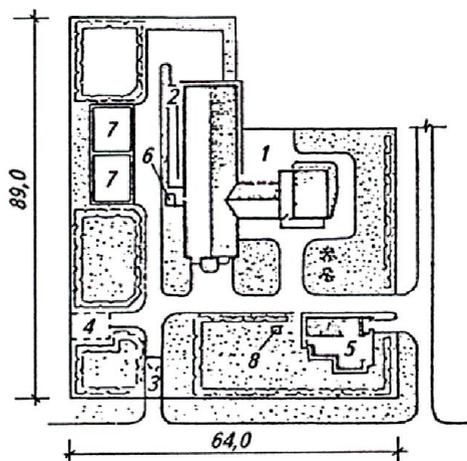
Генеральный план семейной фермы по выращиванию и откорму 200 свиней в год:
